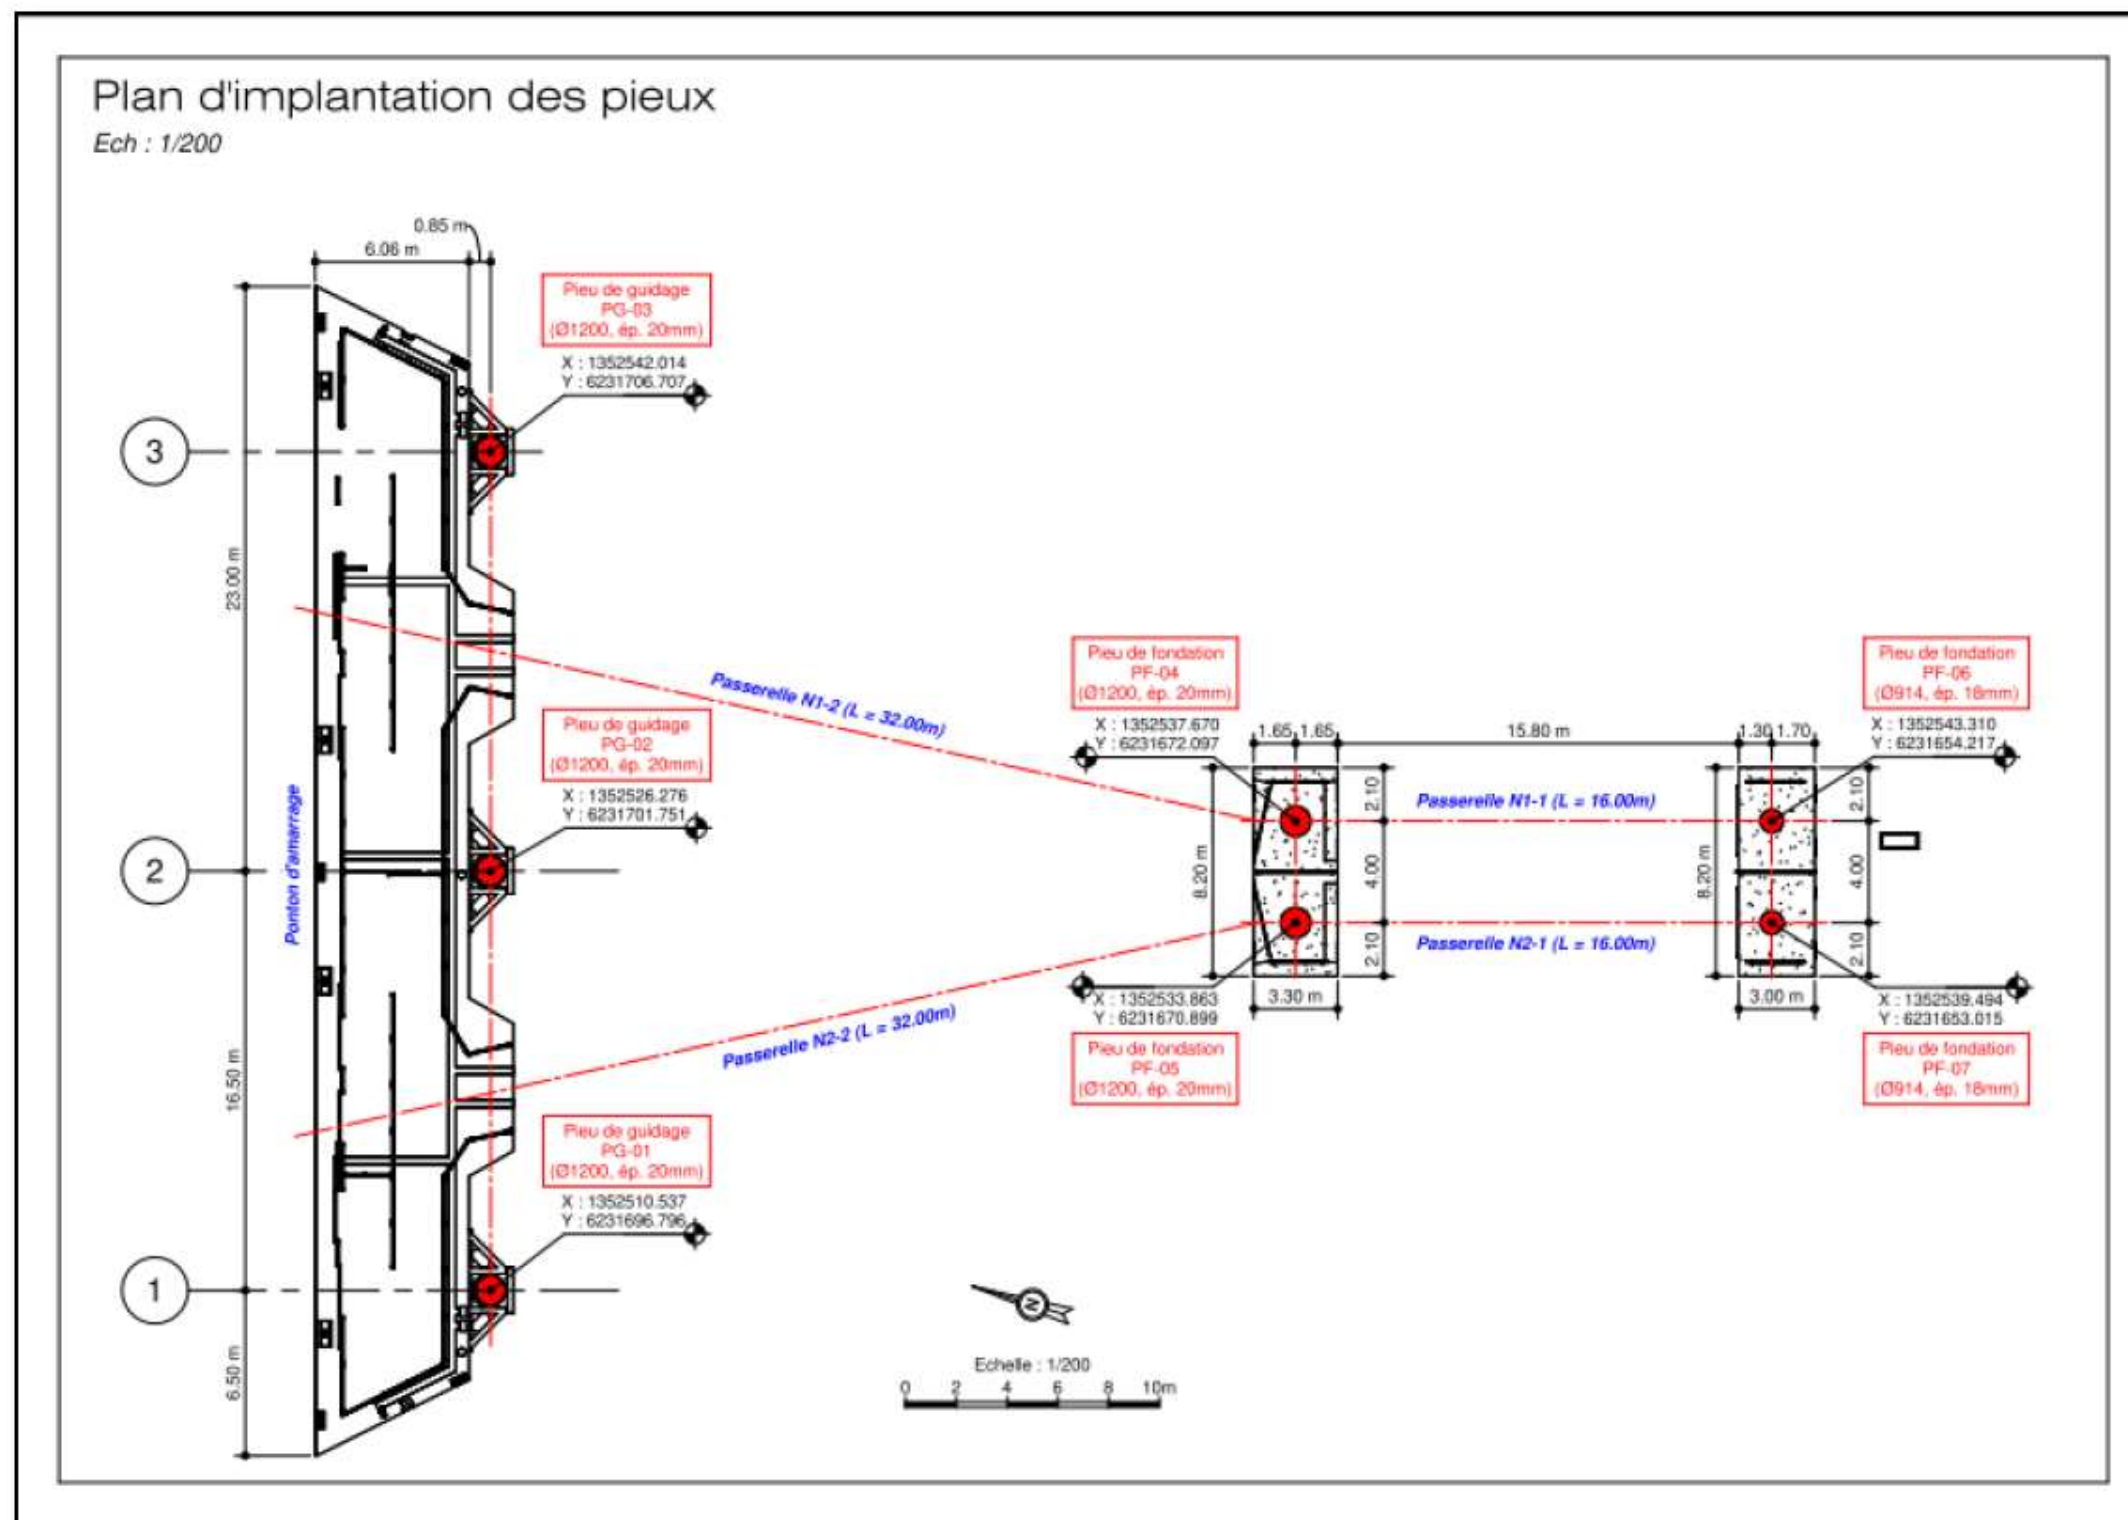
Plan détaillé des passerelles mobiles (AVP)
